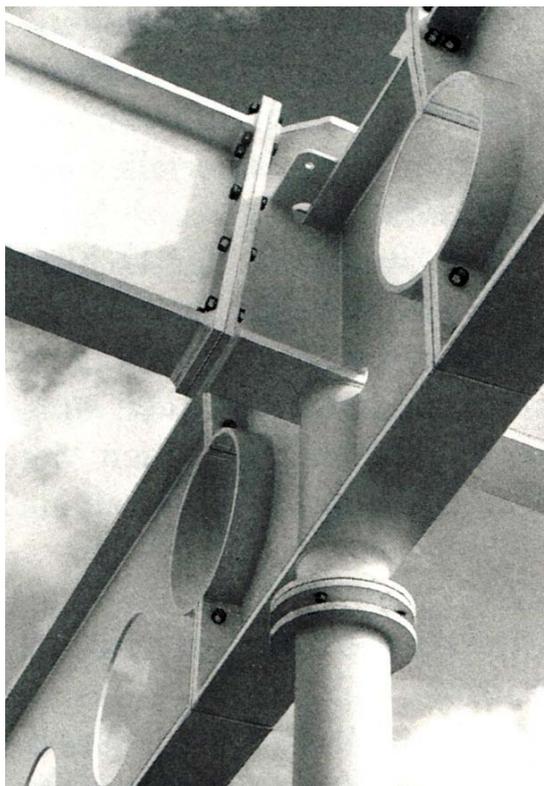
Detalhe de ligação do pilar e vigas “I” com alturas diferentes.
